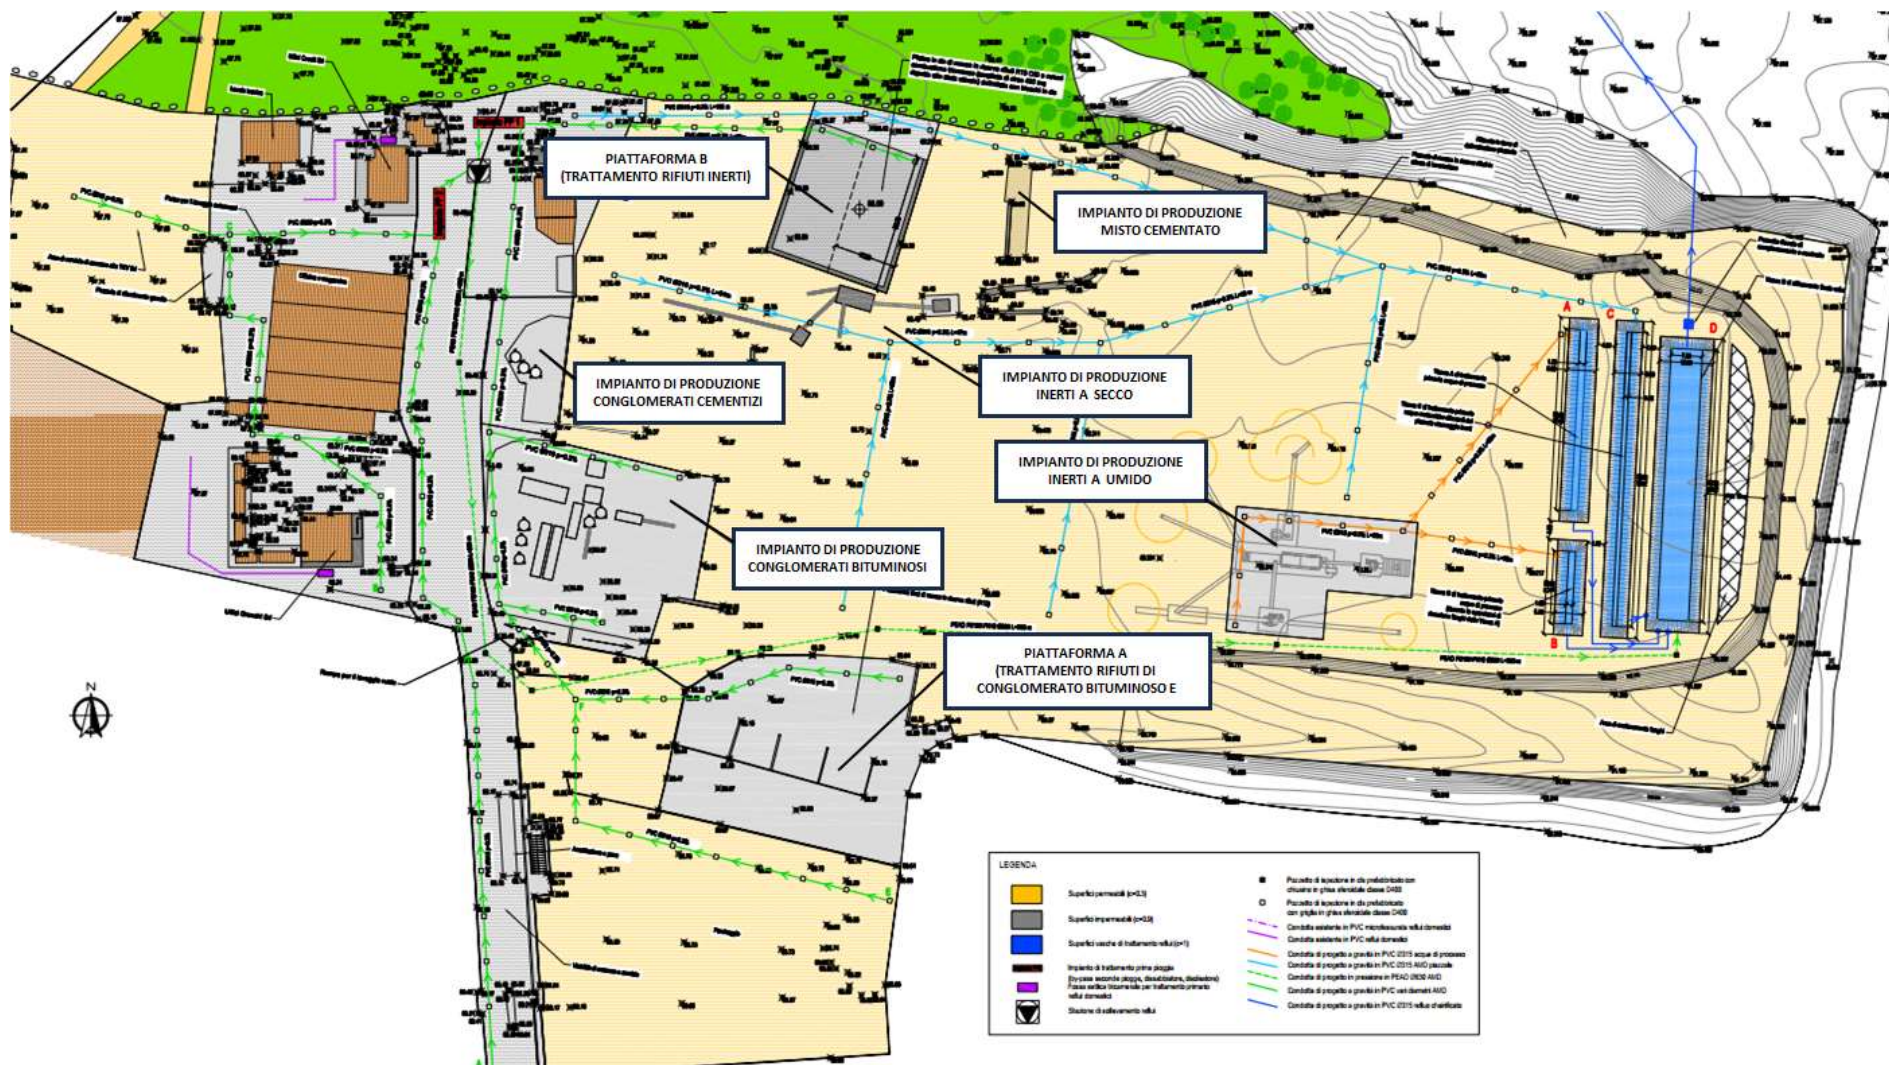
Tavola 3A Planimetria di Progetto Stato Variante Stralcio 2
